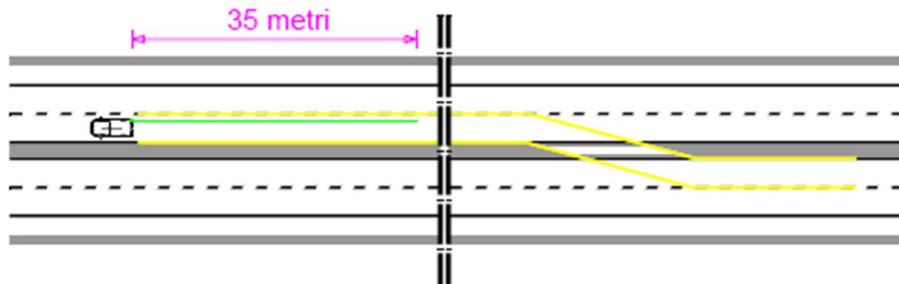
Prima configurazione alternativa _ Dispositivo Single Sentry Beam installato sul mezzo d'opera
